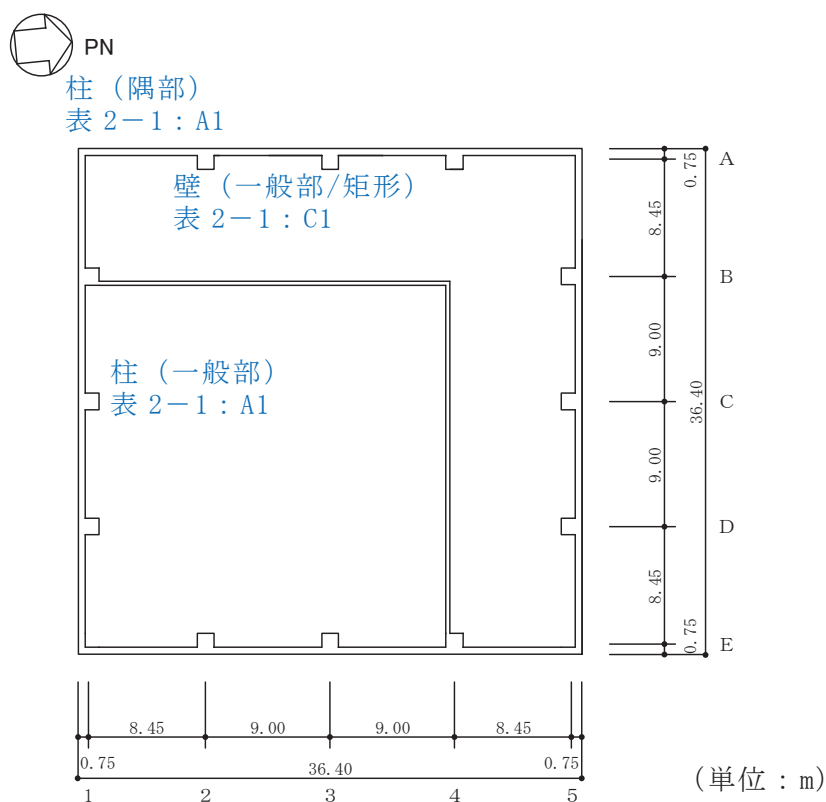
(4) 緊急時対策建屋の概略平面図 (0. P. 69. 4m)
